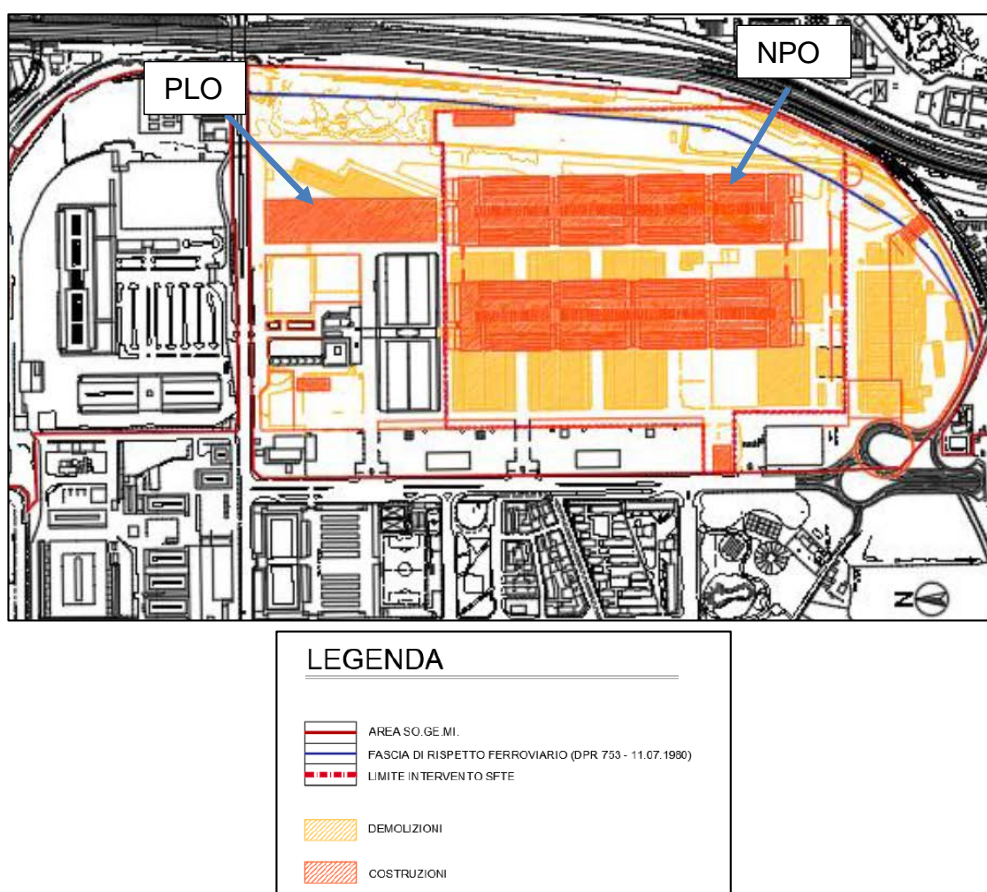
planimetria generale con indicazione delle demolizioni e costruzioni previste nel progetto.
